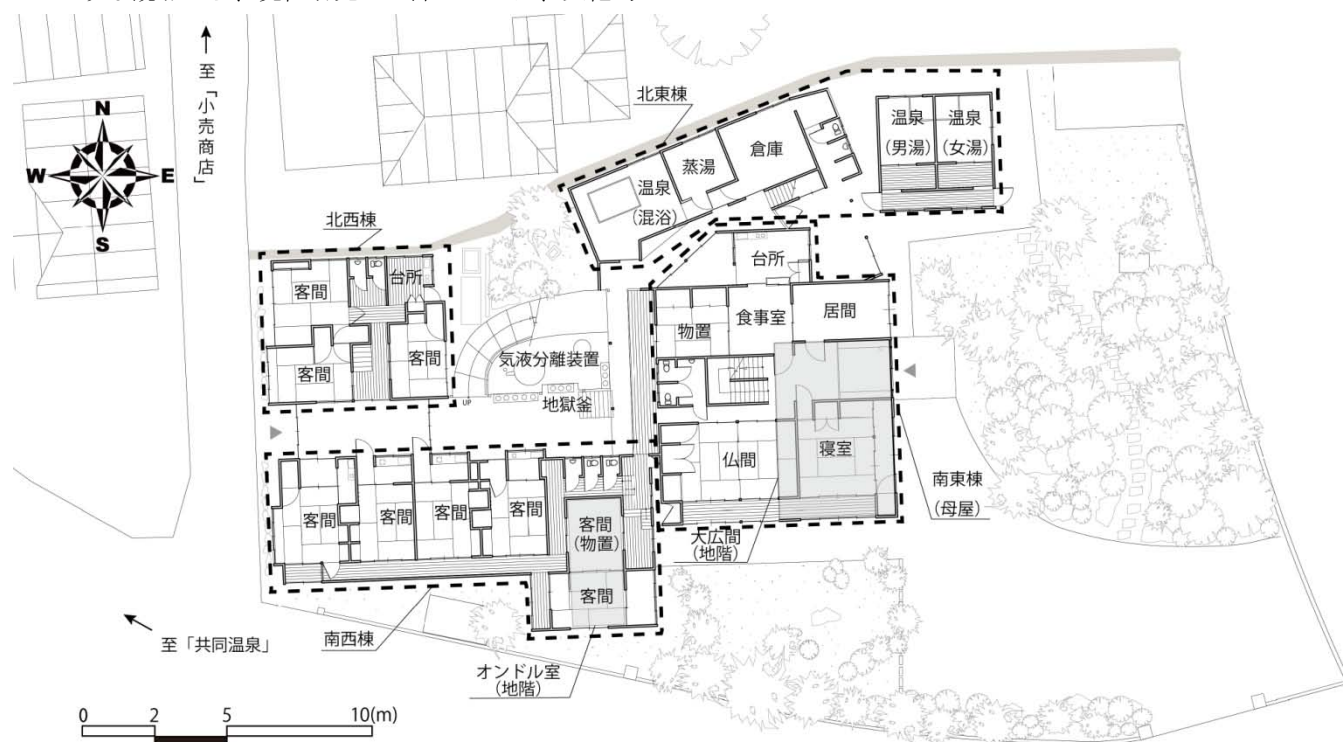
鉄輪温泉地区 貸間旅館F 建築平面図
